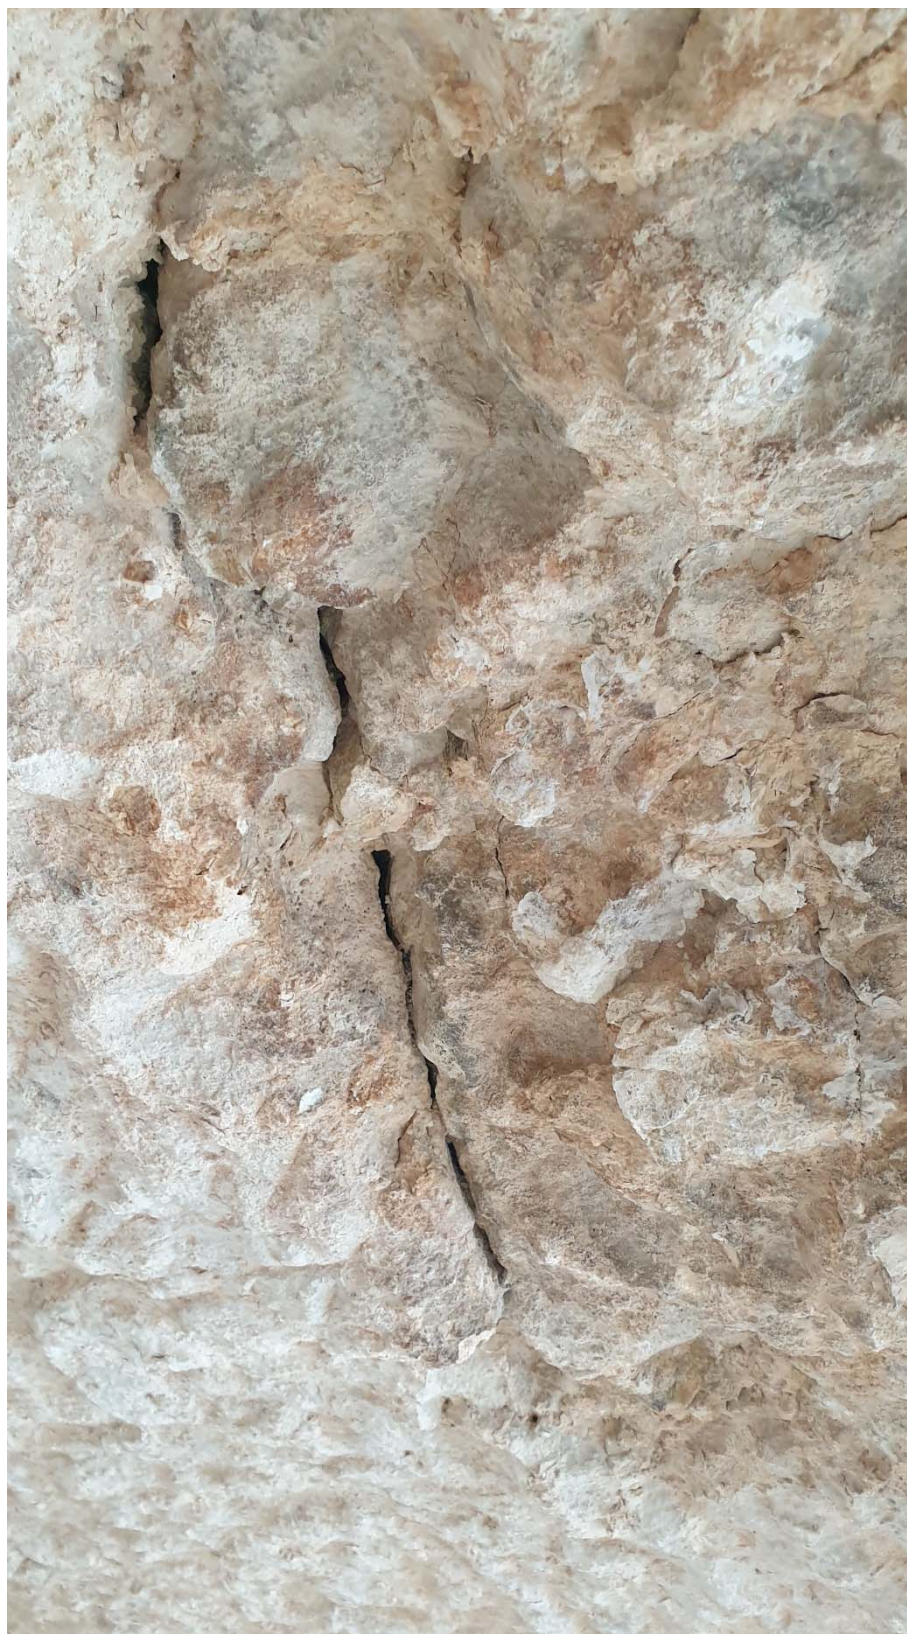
Ampia lesione nel corpo dell'ammasso roccioso lungo la parete.
